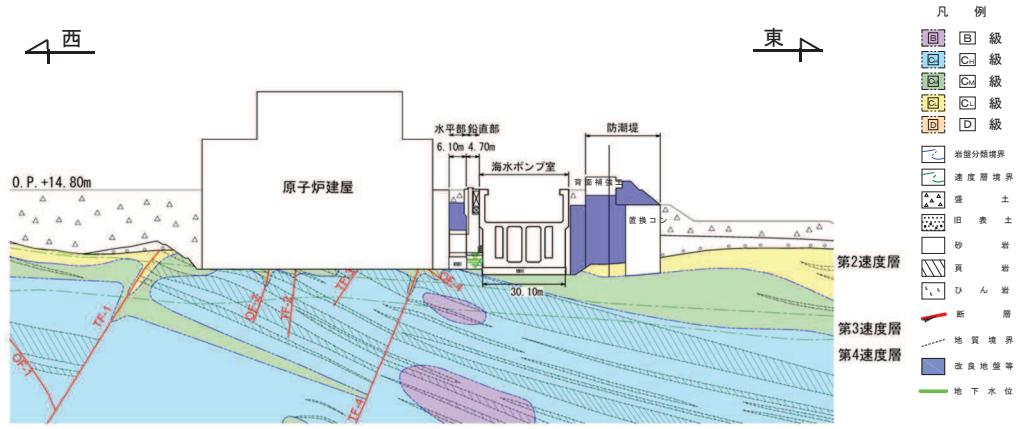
原子炉機器冷却海水配管ダクト（水平部）地質断面図（B-B）
